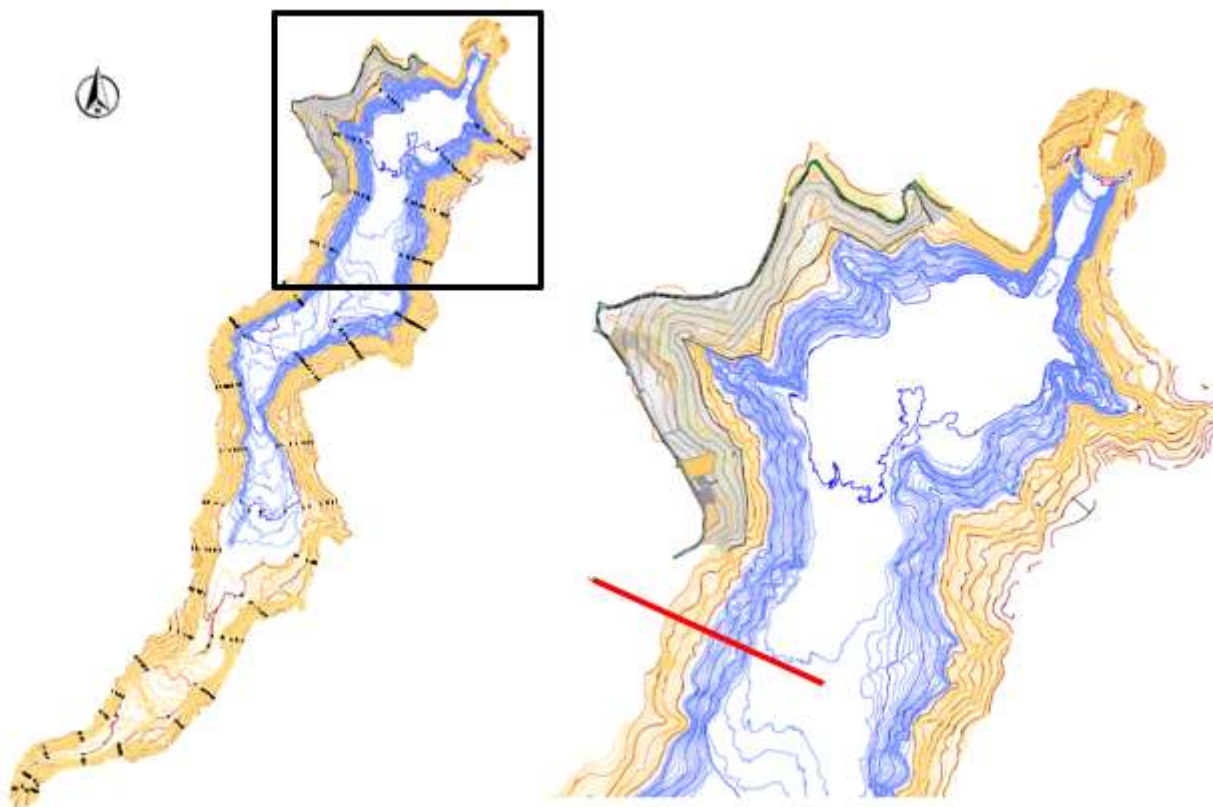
Stralcio planimetrico del bacino di invaso con indicazione della sezione di studio.
